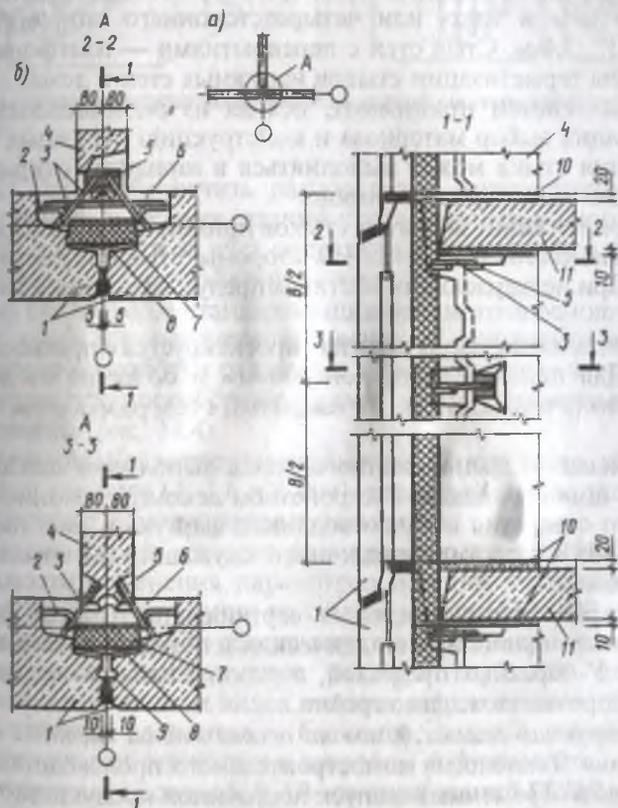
Узлы сопряжений конструктивных элементов крупнопанельных 5...9-этажных зданий со смешанным шагом поперечных несущих стен:
